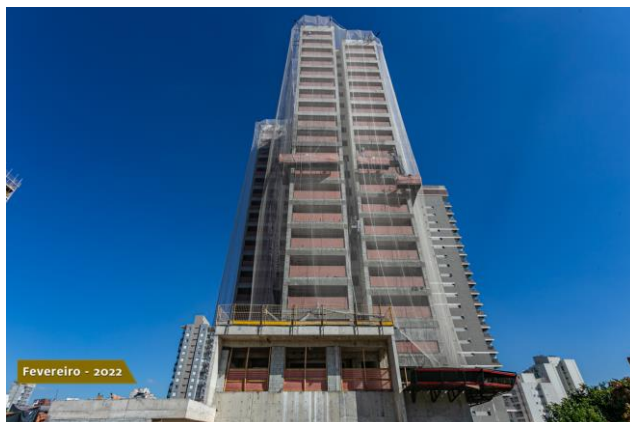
Fachada do empreendimento com 20 pavimentos construídos.
